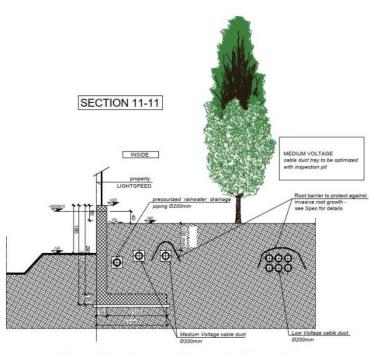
Prospetto servizi adiacenti recinzione lato Sud
